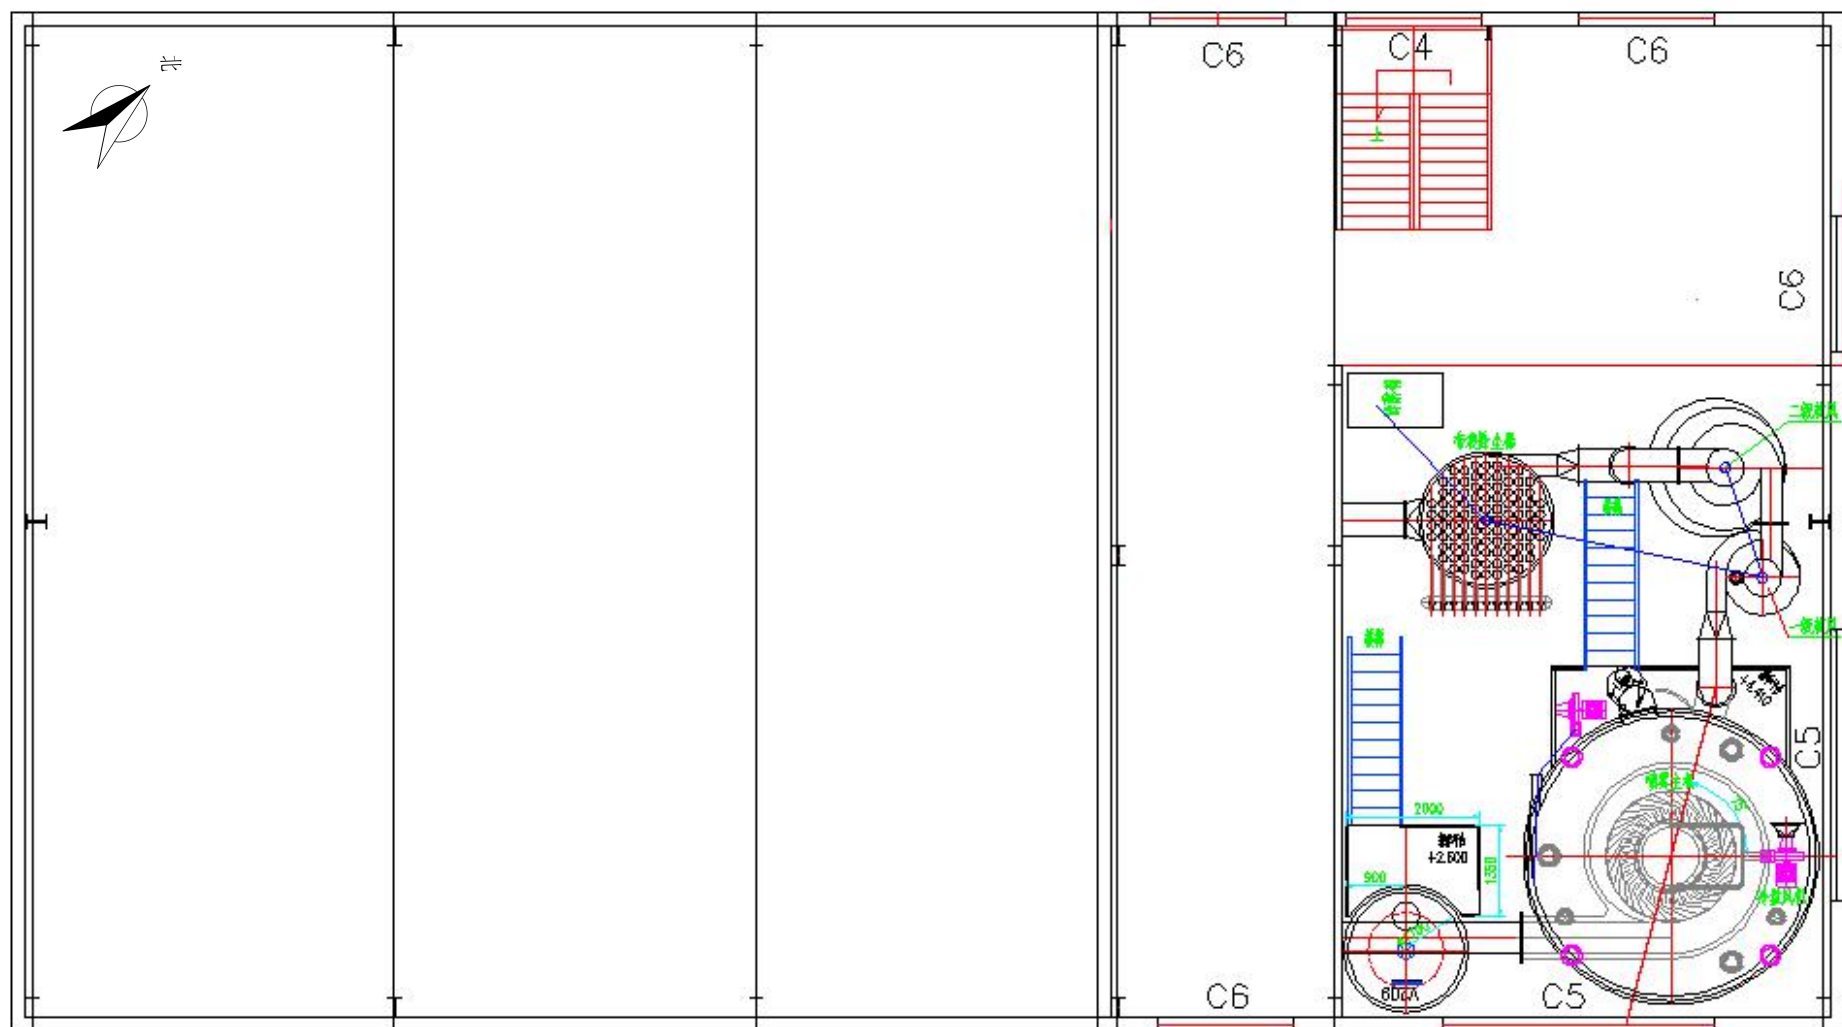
3#2 层喷雾干燥车间平面布局图（示意）
